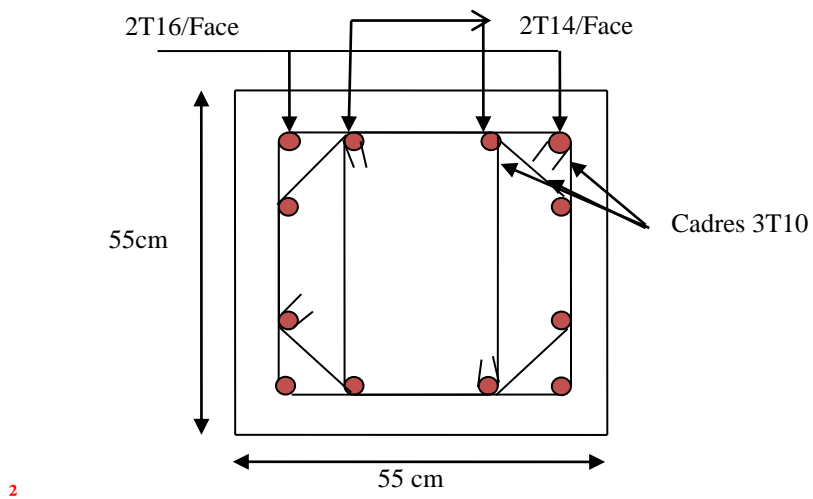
Schéma de ferrailage des poteaux de 7,8 étages.
